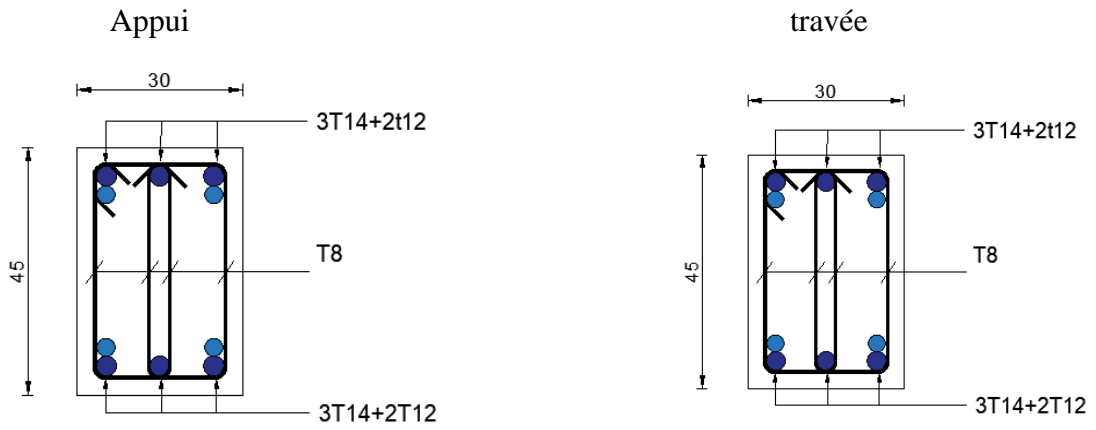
schéma de ferraillages des poutres secondaire (9^{ème} étage)
